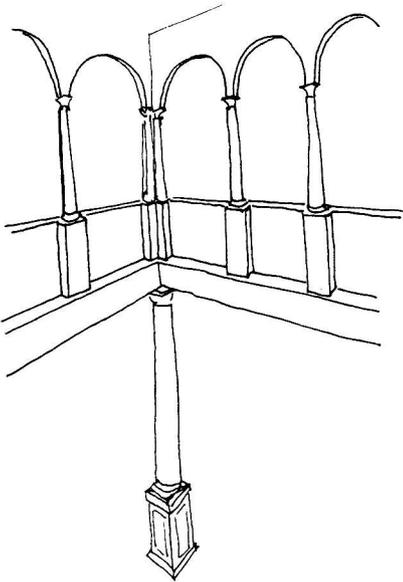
San Blas 6. Reconstrucción ideal del patio a partir de los elementos existentes. La columna toscana sobre plinto de la planta baja no corresponde al estado original.
